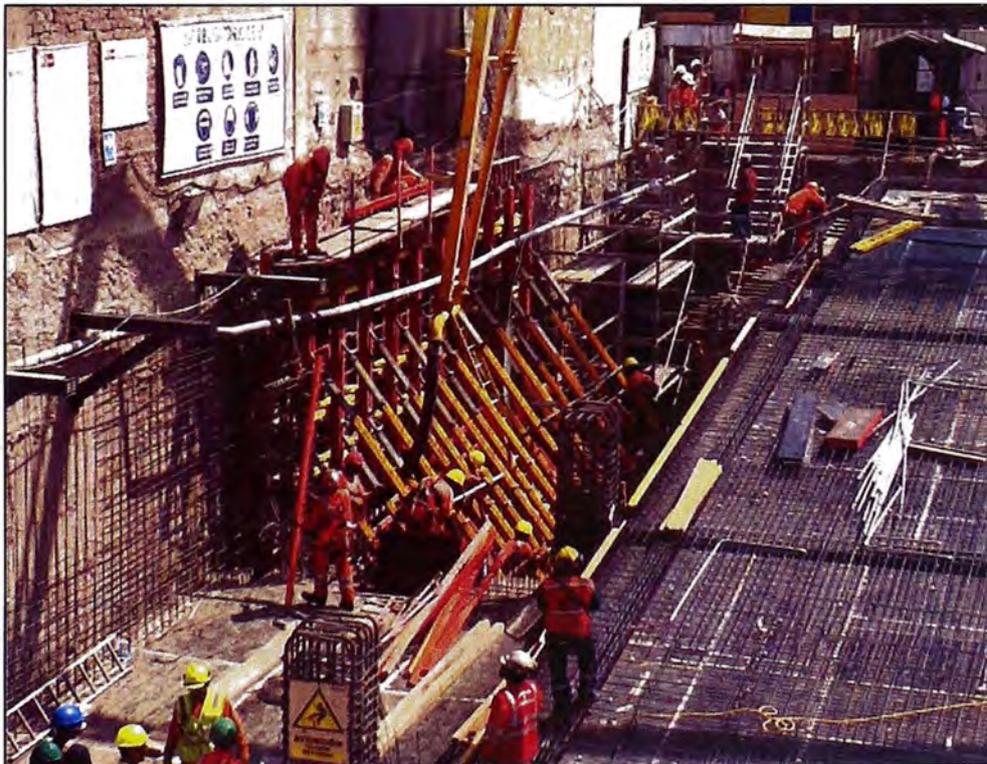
Vaciado de concreto premezclado en Muro Pantalla
